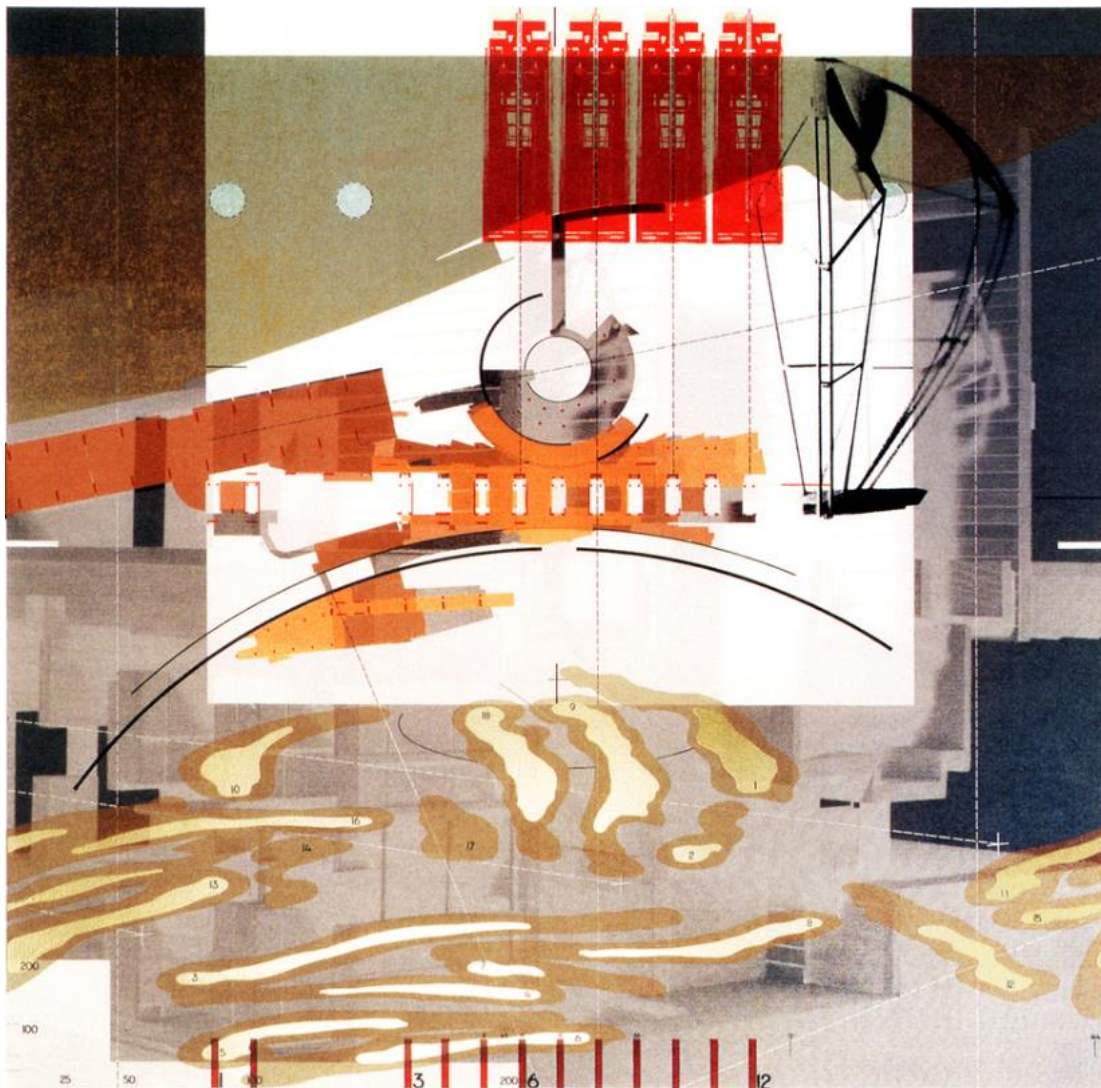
ภาพ plan และ elevation ของโครงการ Chiba Golf Course โดย Thom Mayne (1987)
